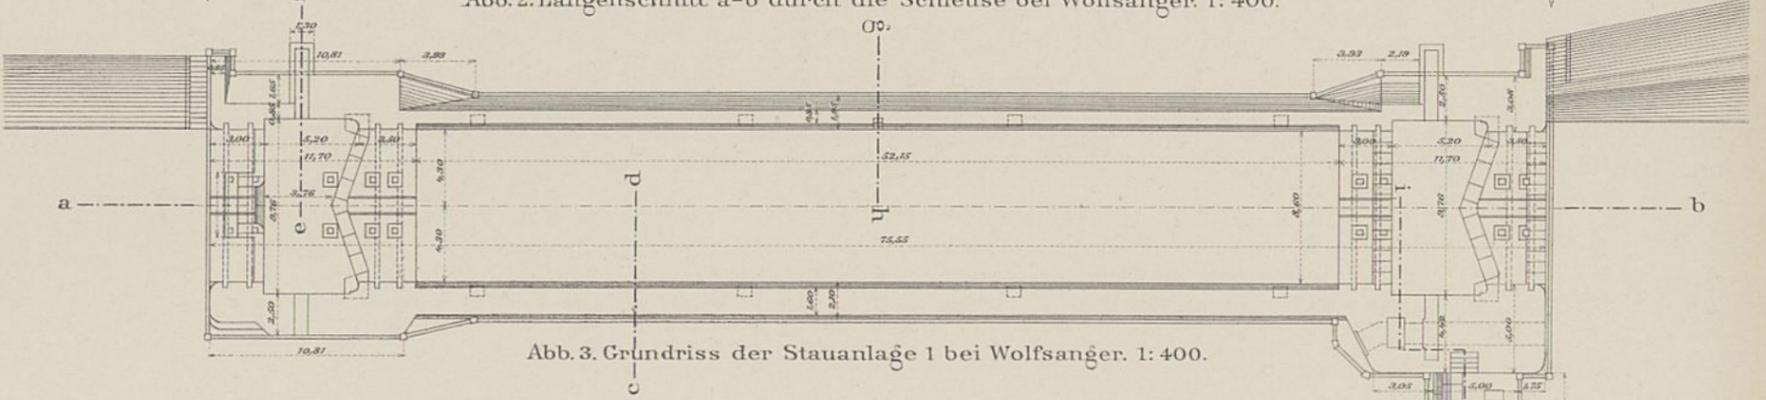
Grundriss der Stauanlage 1 bei Wolfsanger. 1: 400.
